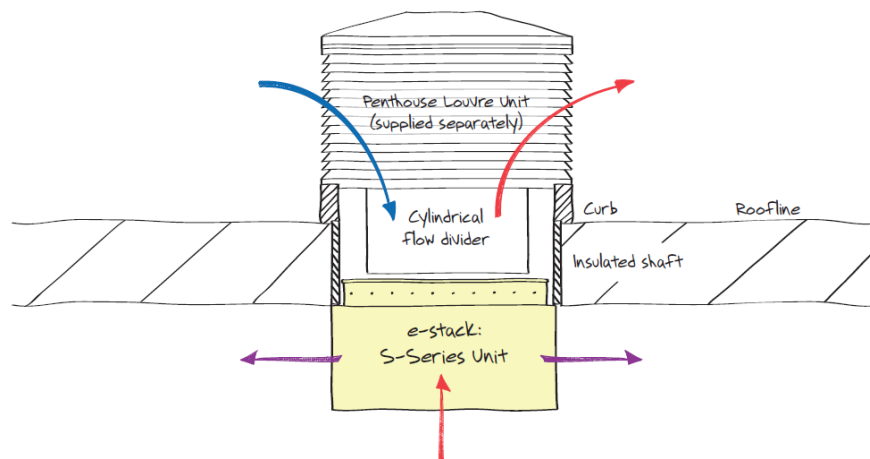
Sistema de ventilação e-stack desenvolvido pela Breathing Buildings (adaptado de [www.breathingbuildings.com](http://www.breathingbuildings.com))
